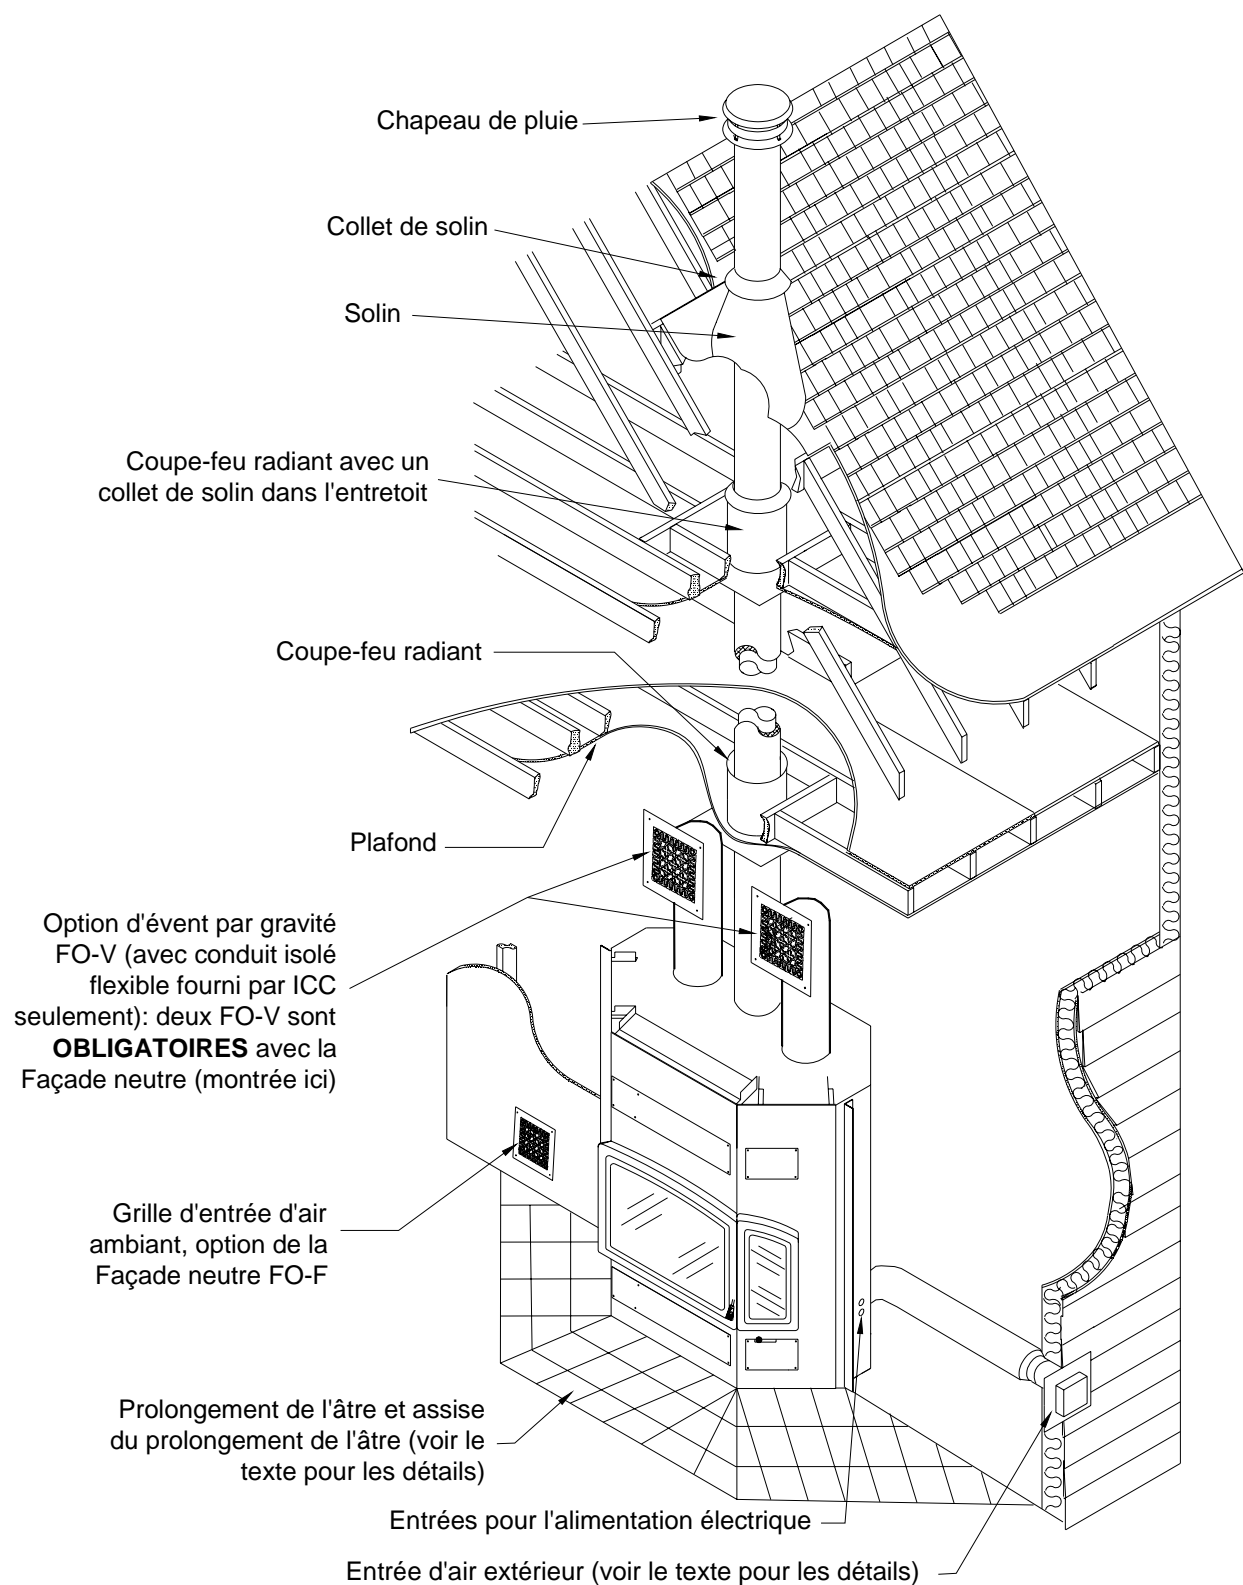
Installation générale d'un DELTA2 avec Façade Neutre
